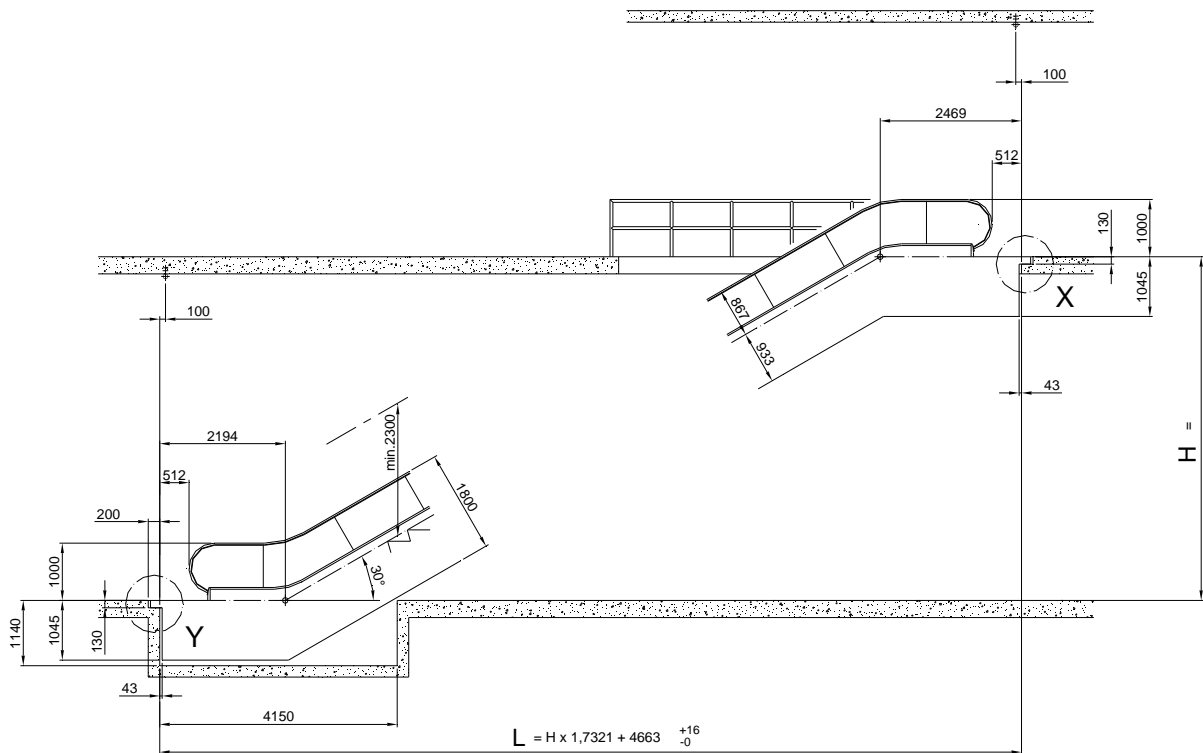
Dimensiones de la escalera. Alzado lateral
